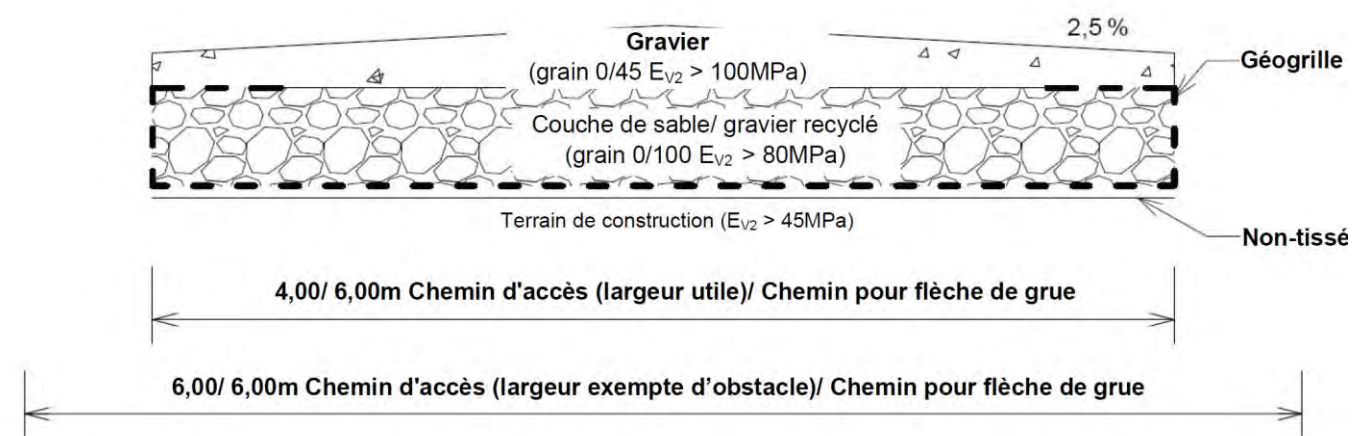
Exemple de coupe transversale d'une piste d'accès ©WPD
